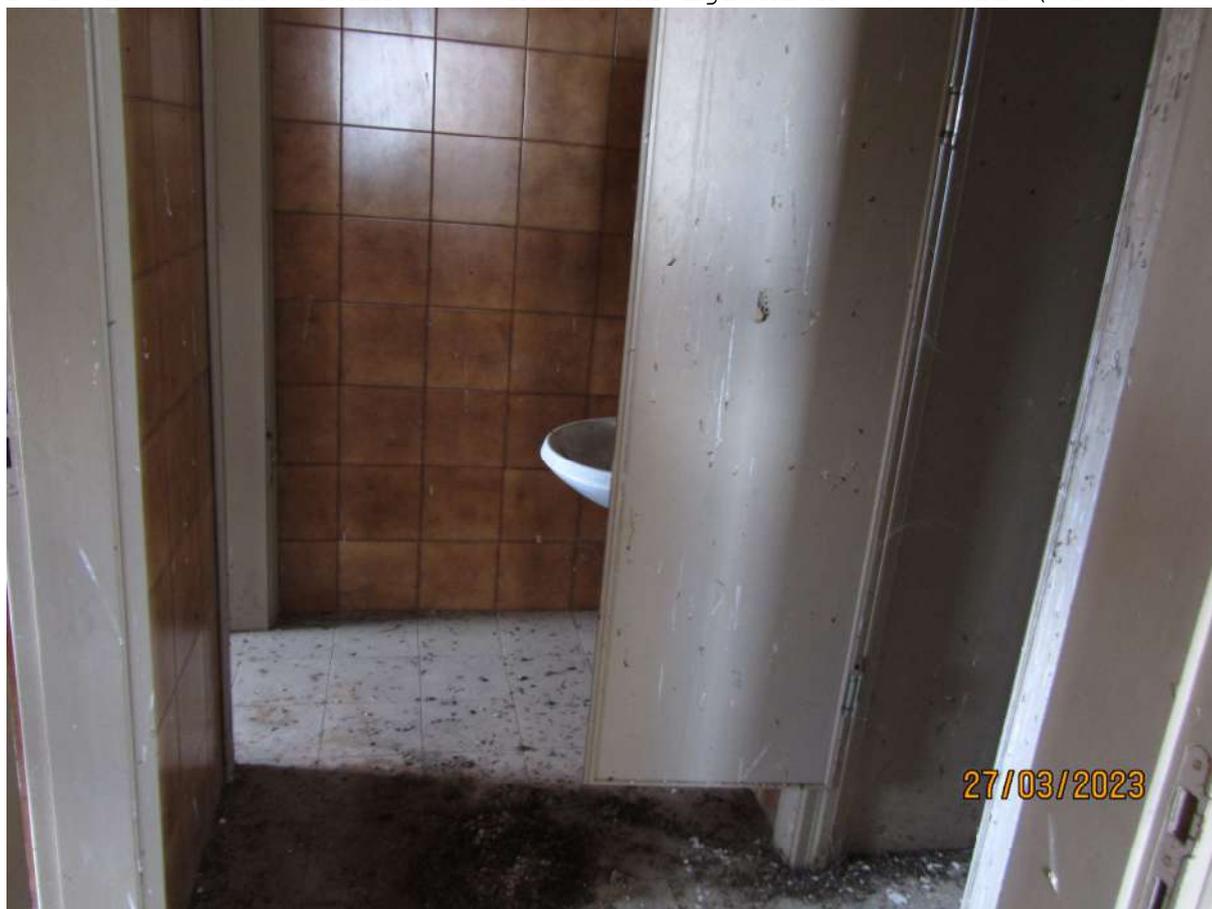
PIANO PRIMO - Condizioni igieniche attuali (area W.C.).
